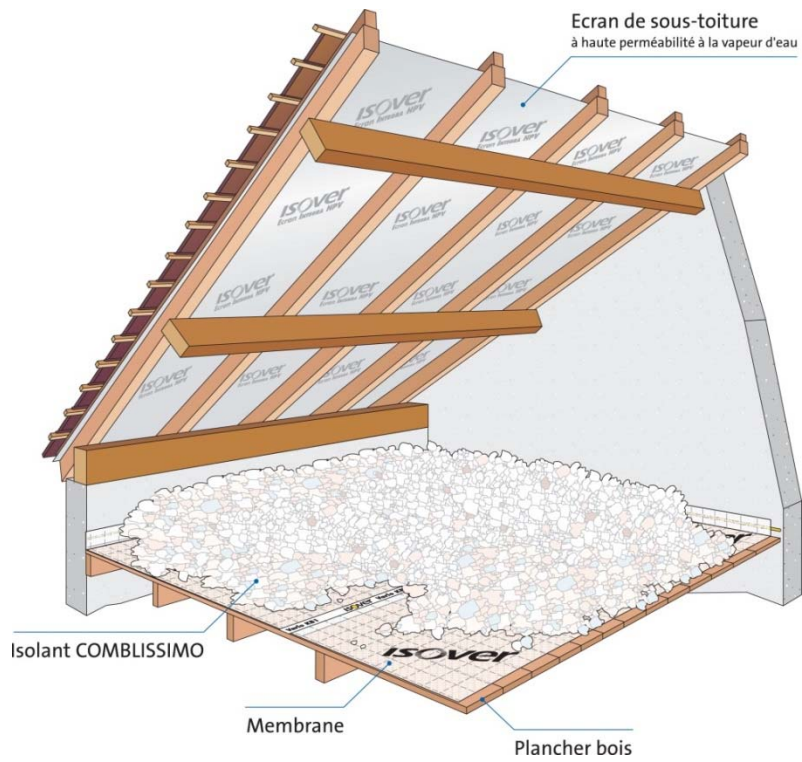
Pose sur plancher de comble perdu : mise en œuvre d'isolant en vrac sur plancher de comble perdu
